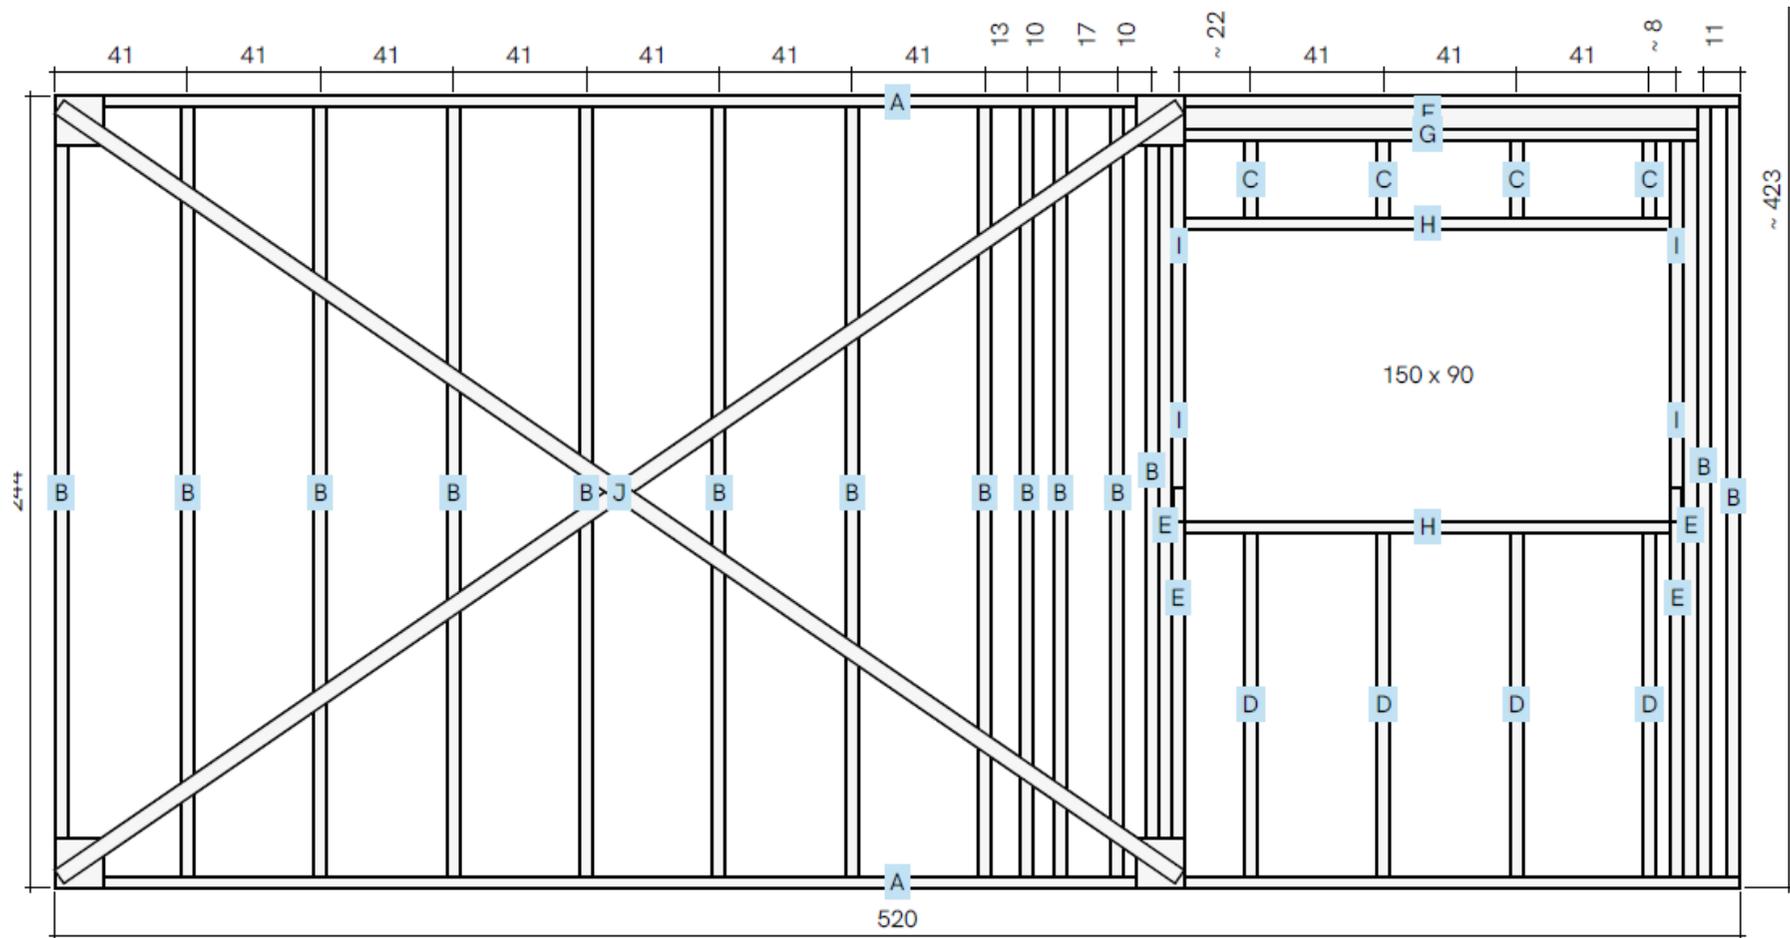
Andino, E. (2020)*. Diseño de paneles típicos para obra en Steel Frame, para ensamblaje o construcción en obra con detalle de vano de ventana y refuerzo con cruz de arriostramiento. Elaboración propia.
